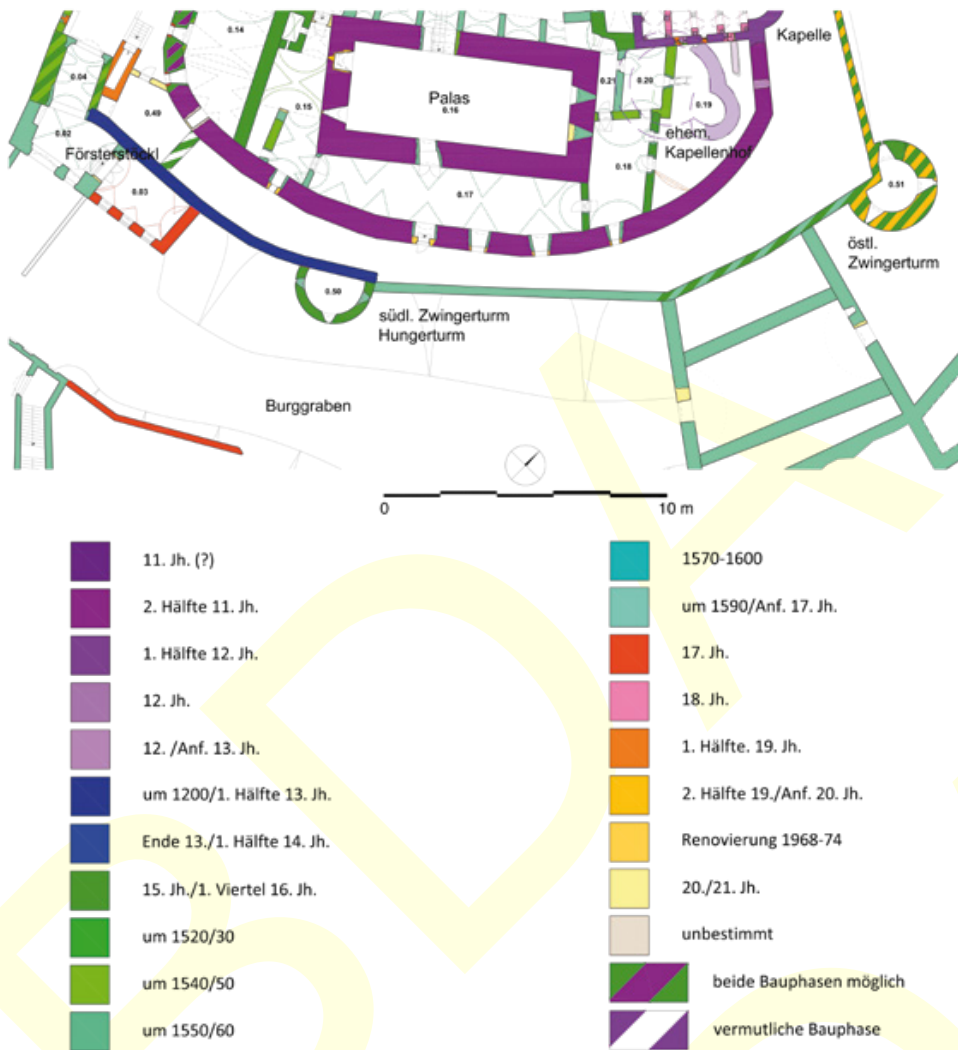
Schallaburg, Burg. Baualterplan des Erdgeschoßes (Ausschnitt mit südöstlichem Zwingler).
